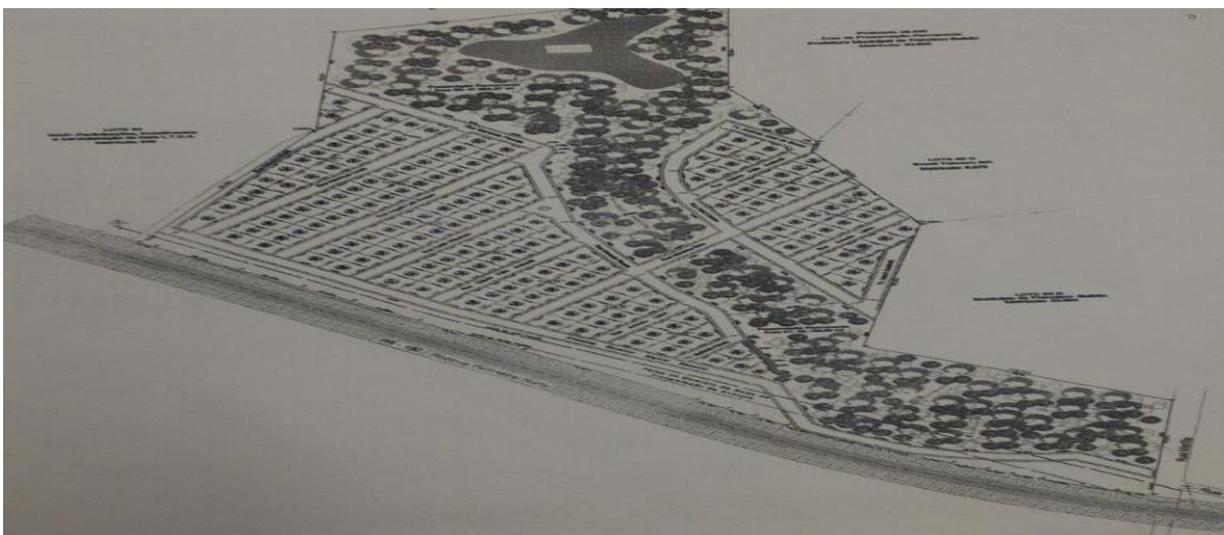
Croqui da planta do Loteamento Lago das Torres
